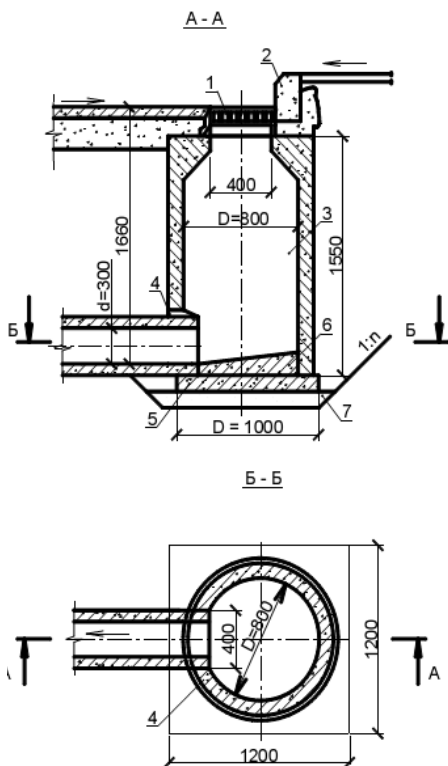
Дождеприемник из сборных железобетонных элементов:
